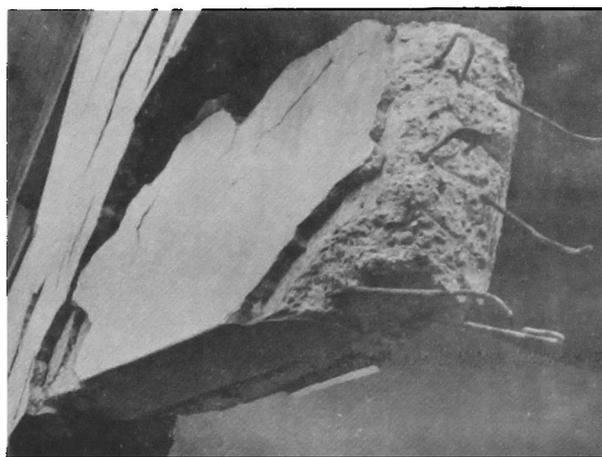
Rotura de anclaje en extremo de viga. Casa en calle Picarte, Valdivia.
